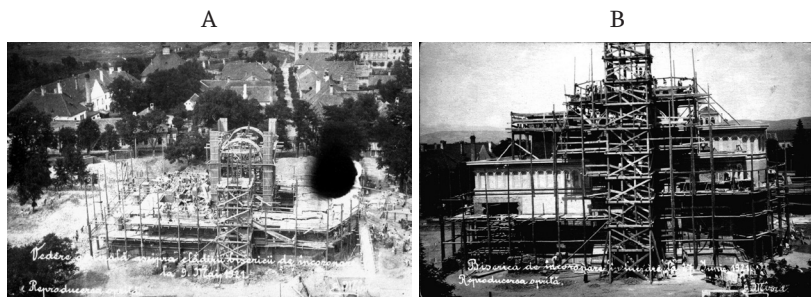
Faze de execuție din cadrul lucrărilor de construcție a Catedralei Încoronării din Alba Iulia: finalizarea radierului, a fundațiilor și plăci de pardoseală de beton armat și începerea lucrărilor de cofrare a celor patru stâlpi masivi cu secțiune octogonală, amplasați la interior, ce susțin turla principală din zona naosului (A), finalizarea pereților perimetrali din zidărie de cărămidă și începerea lucrărilor pentru execuția turelor catedralei (B) [25].
